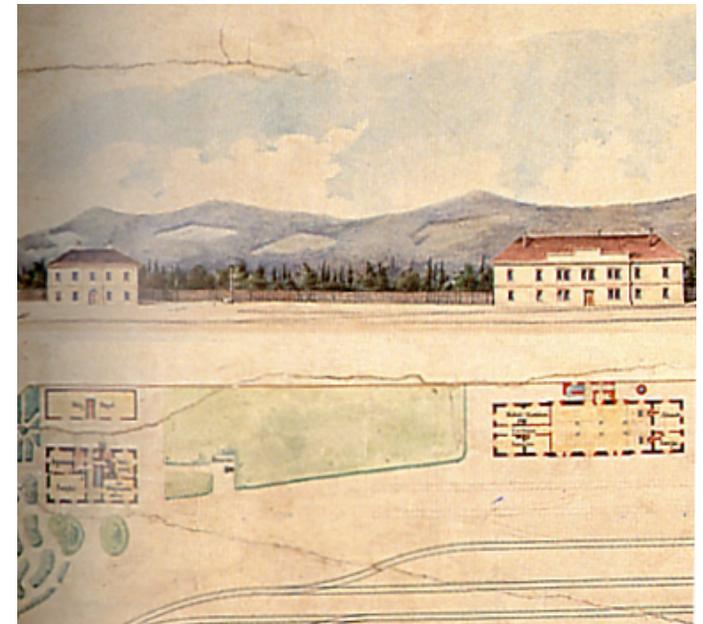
Kanzleigebäude Linz Südbahnhof. Ansichten und Grundrisse, Planausschnitt.
